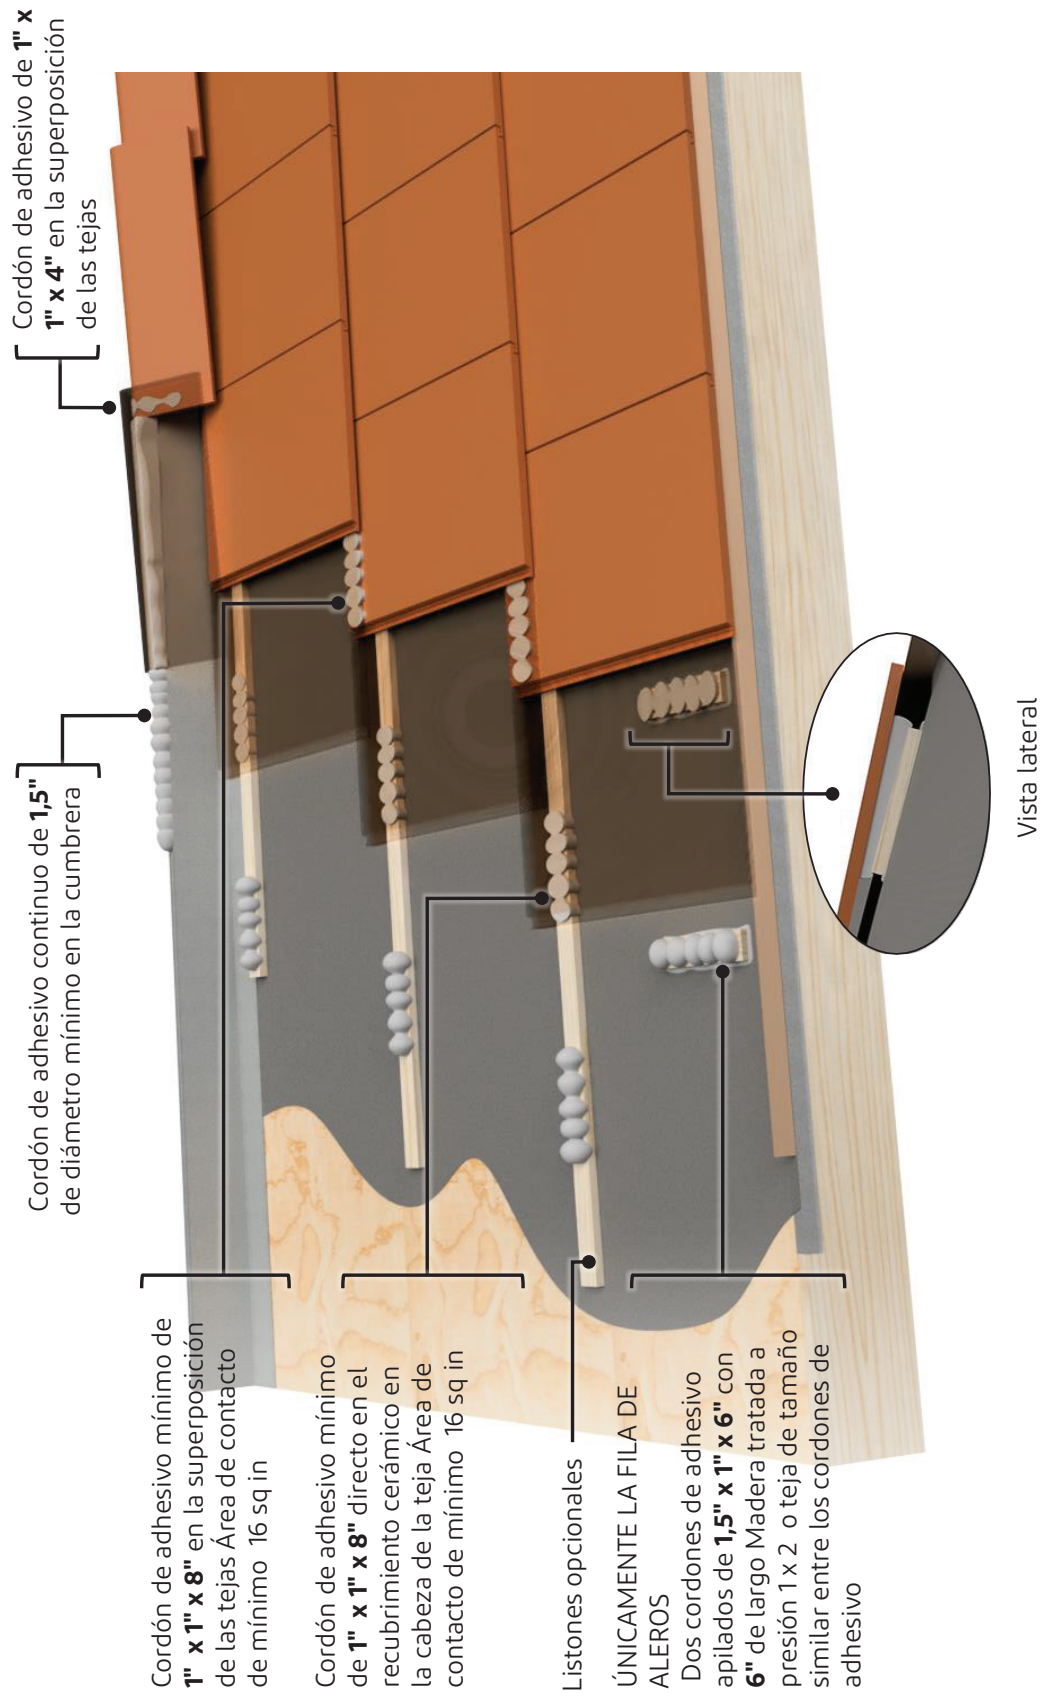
Colocación de adhesivo INDEPENDIENTE de perfil plano
